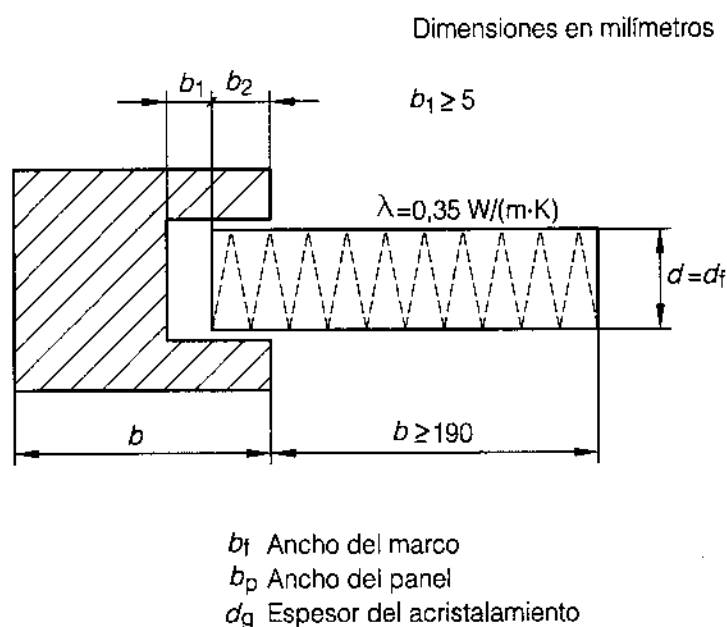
Esquema de la sección de perfil con un panel de aislamiento instalado
